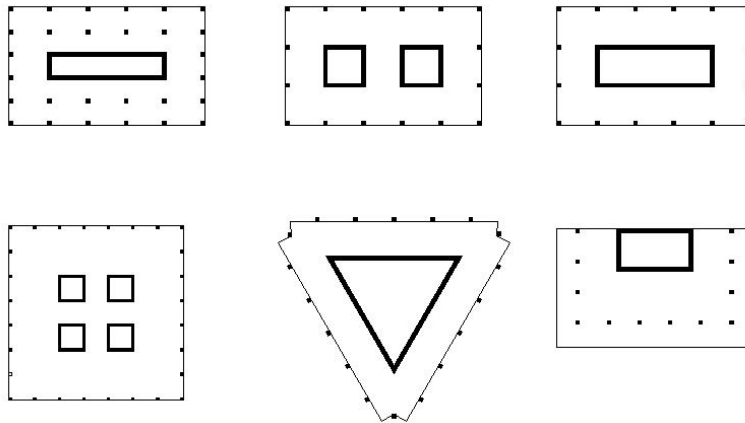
Simetrik ve kapalı perde/çekirdek sistemleri
